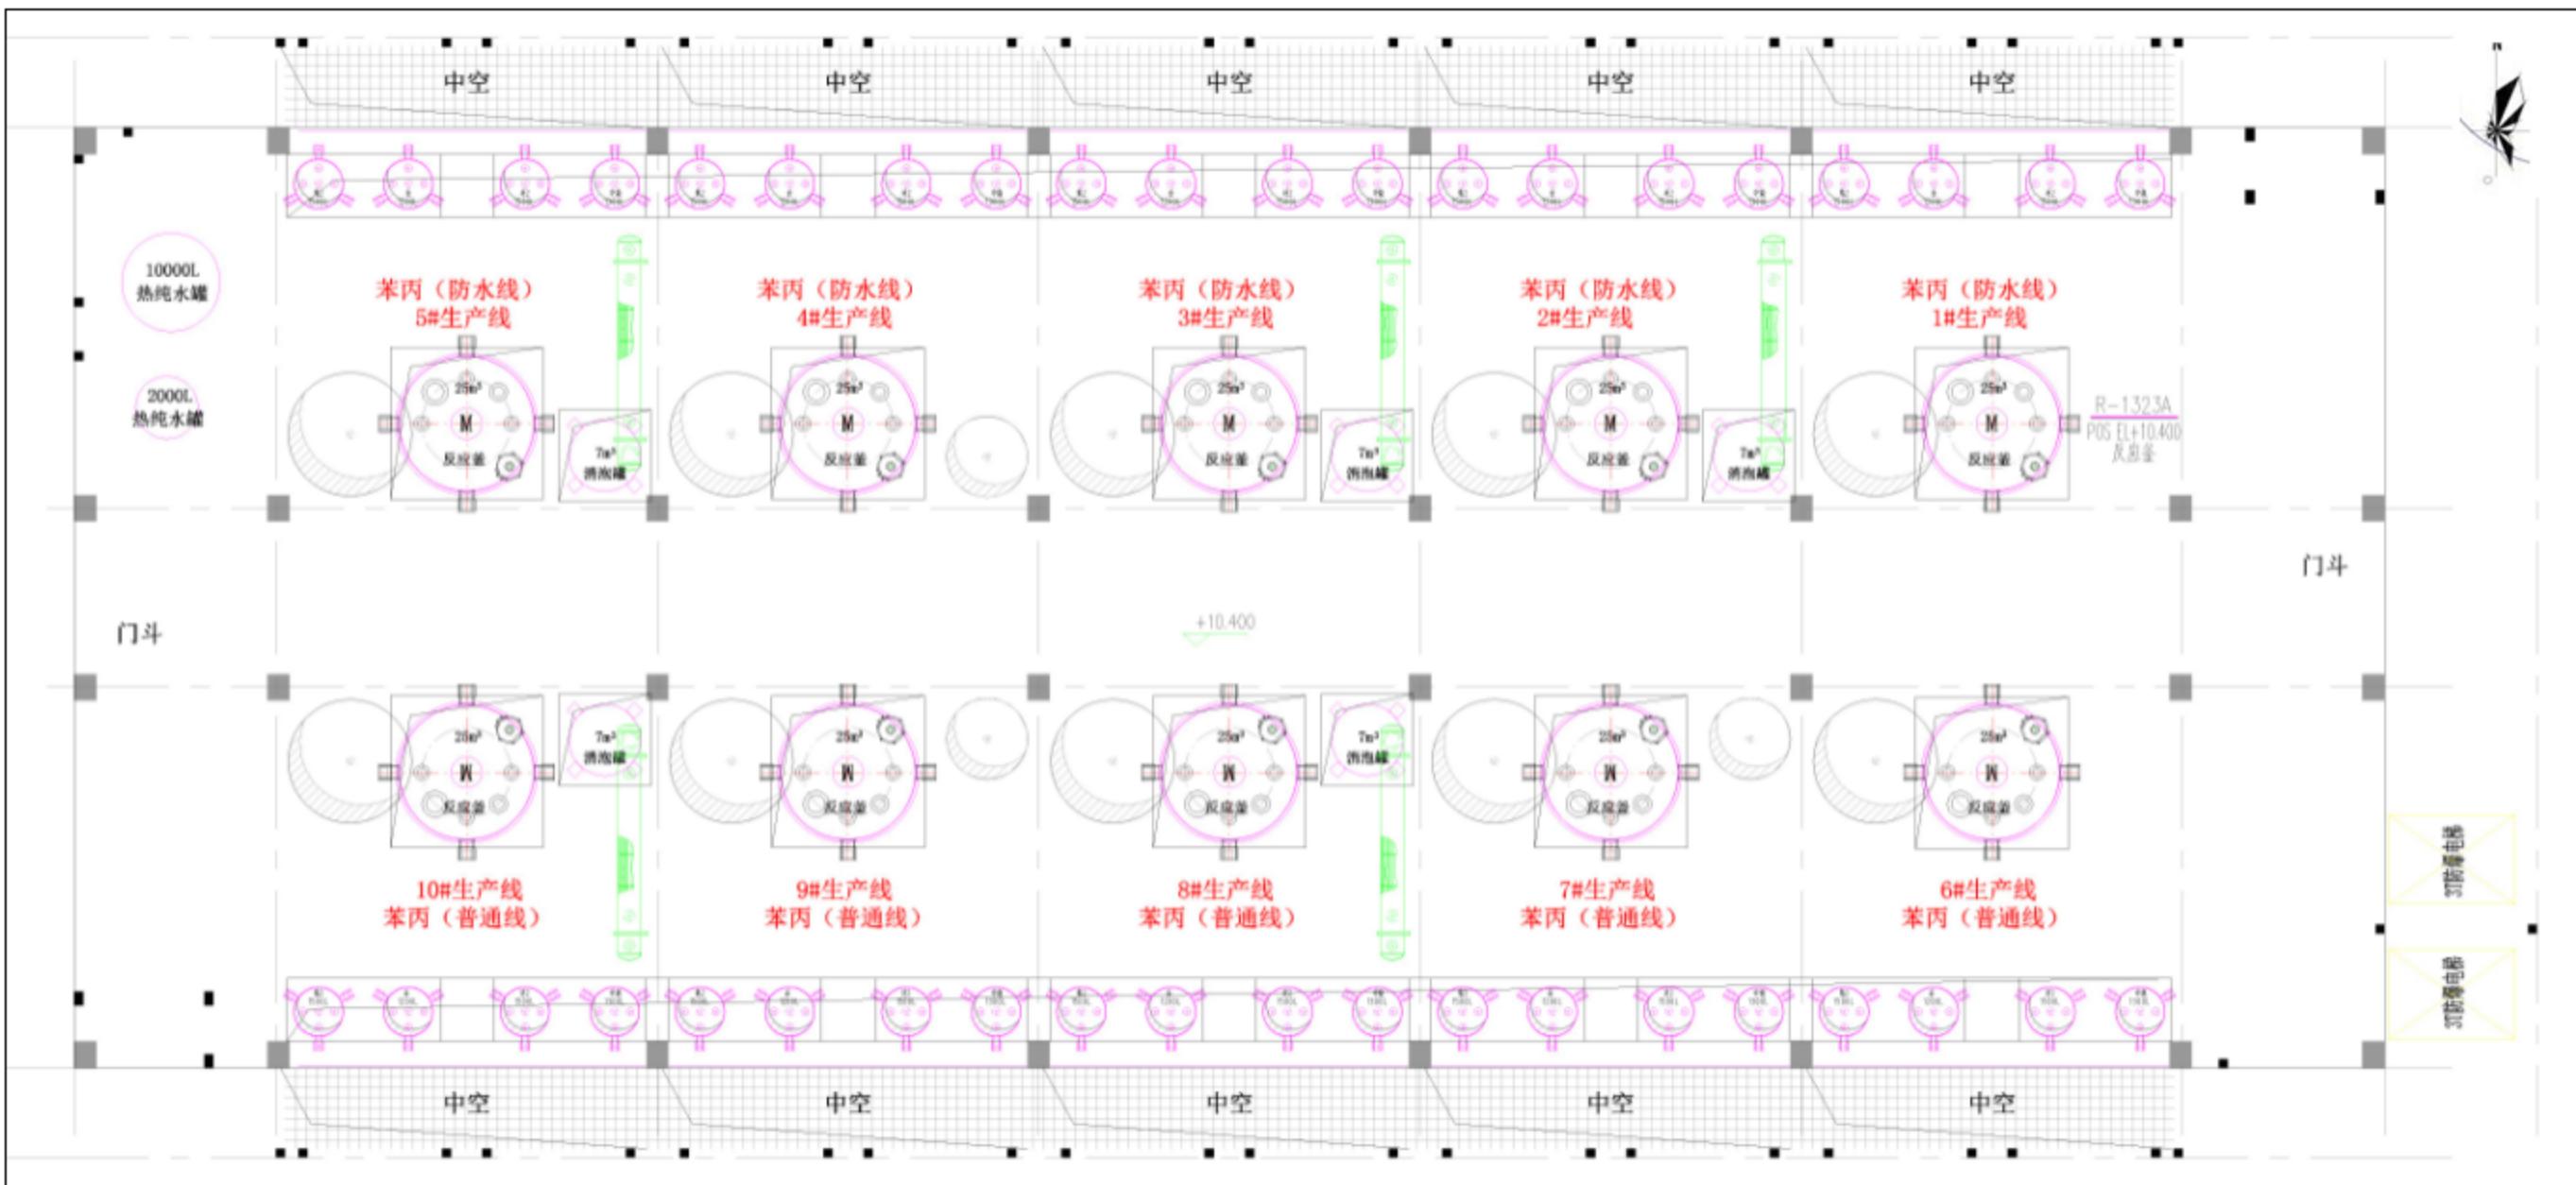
甲类车间A3层平面布置图(比例尺1:100)
